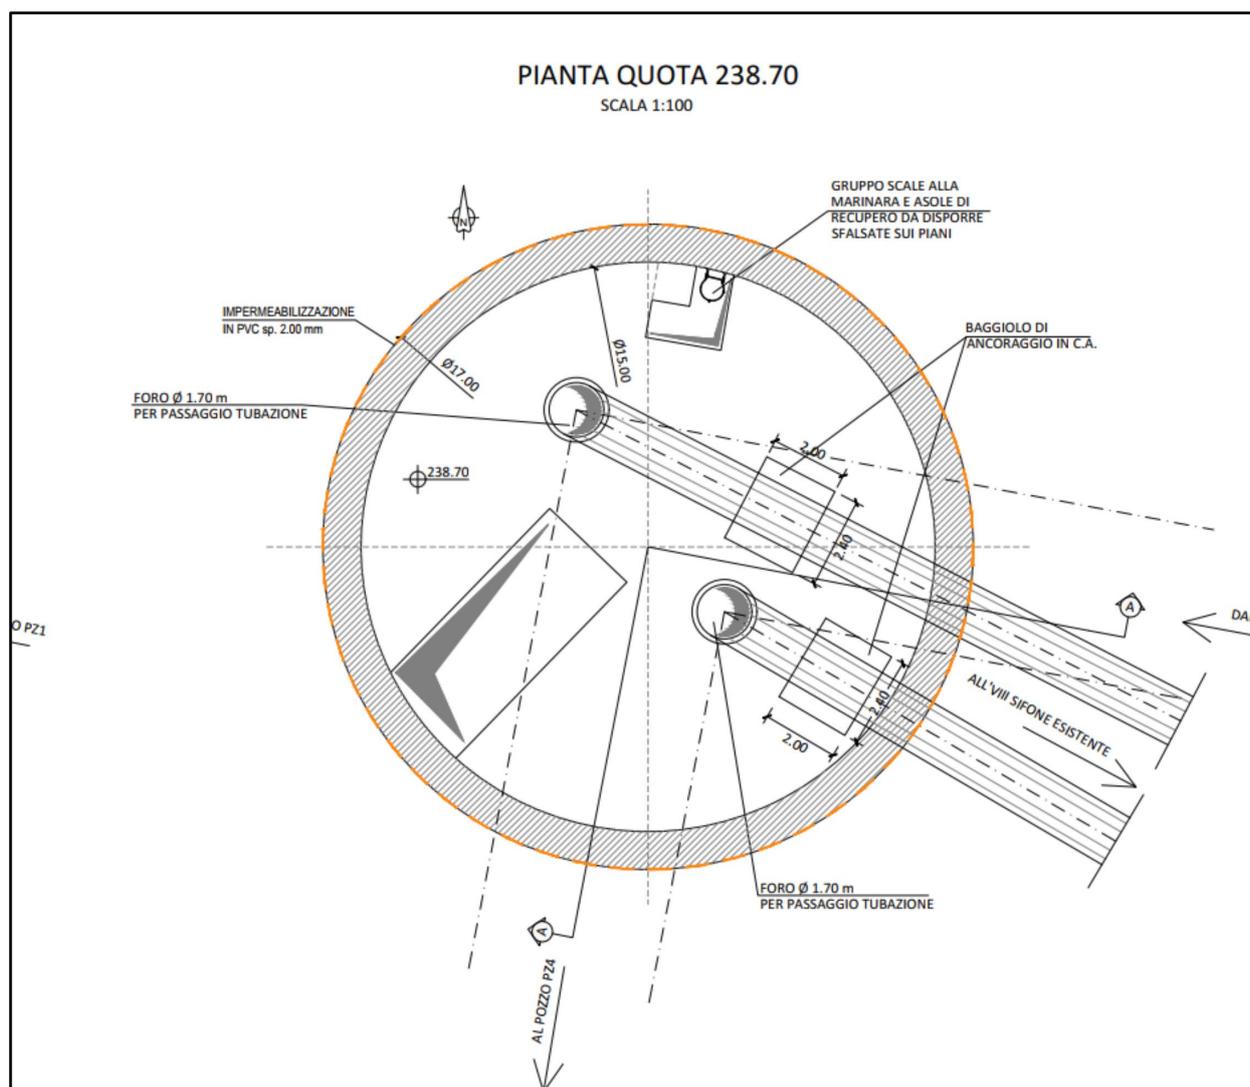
Rappresentazione in pianta del manufatto PZ2
